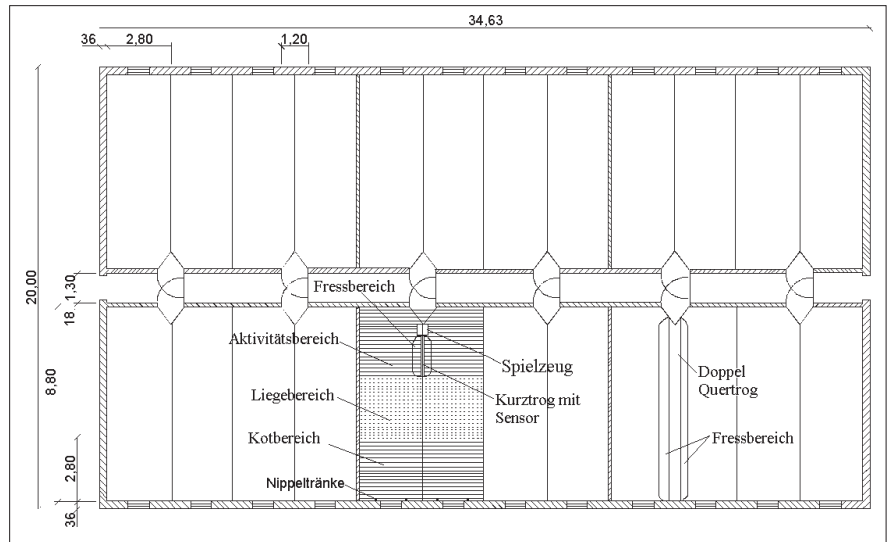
Grundrissbeispiel für einen aufgewerteten konventionellen Spaltenbodenstall mit zentralem Erschließungsgang
